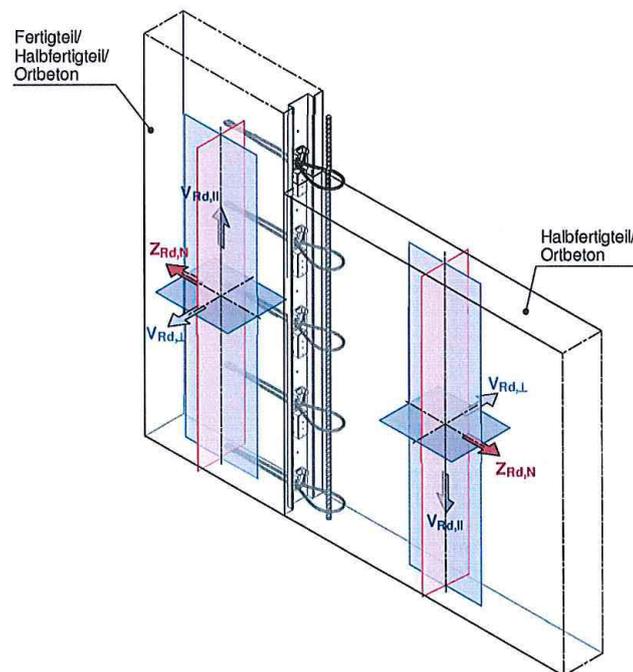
Einbauzustand und Darstellung der zulässigen Belastungsrichtungen
